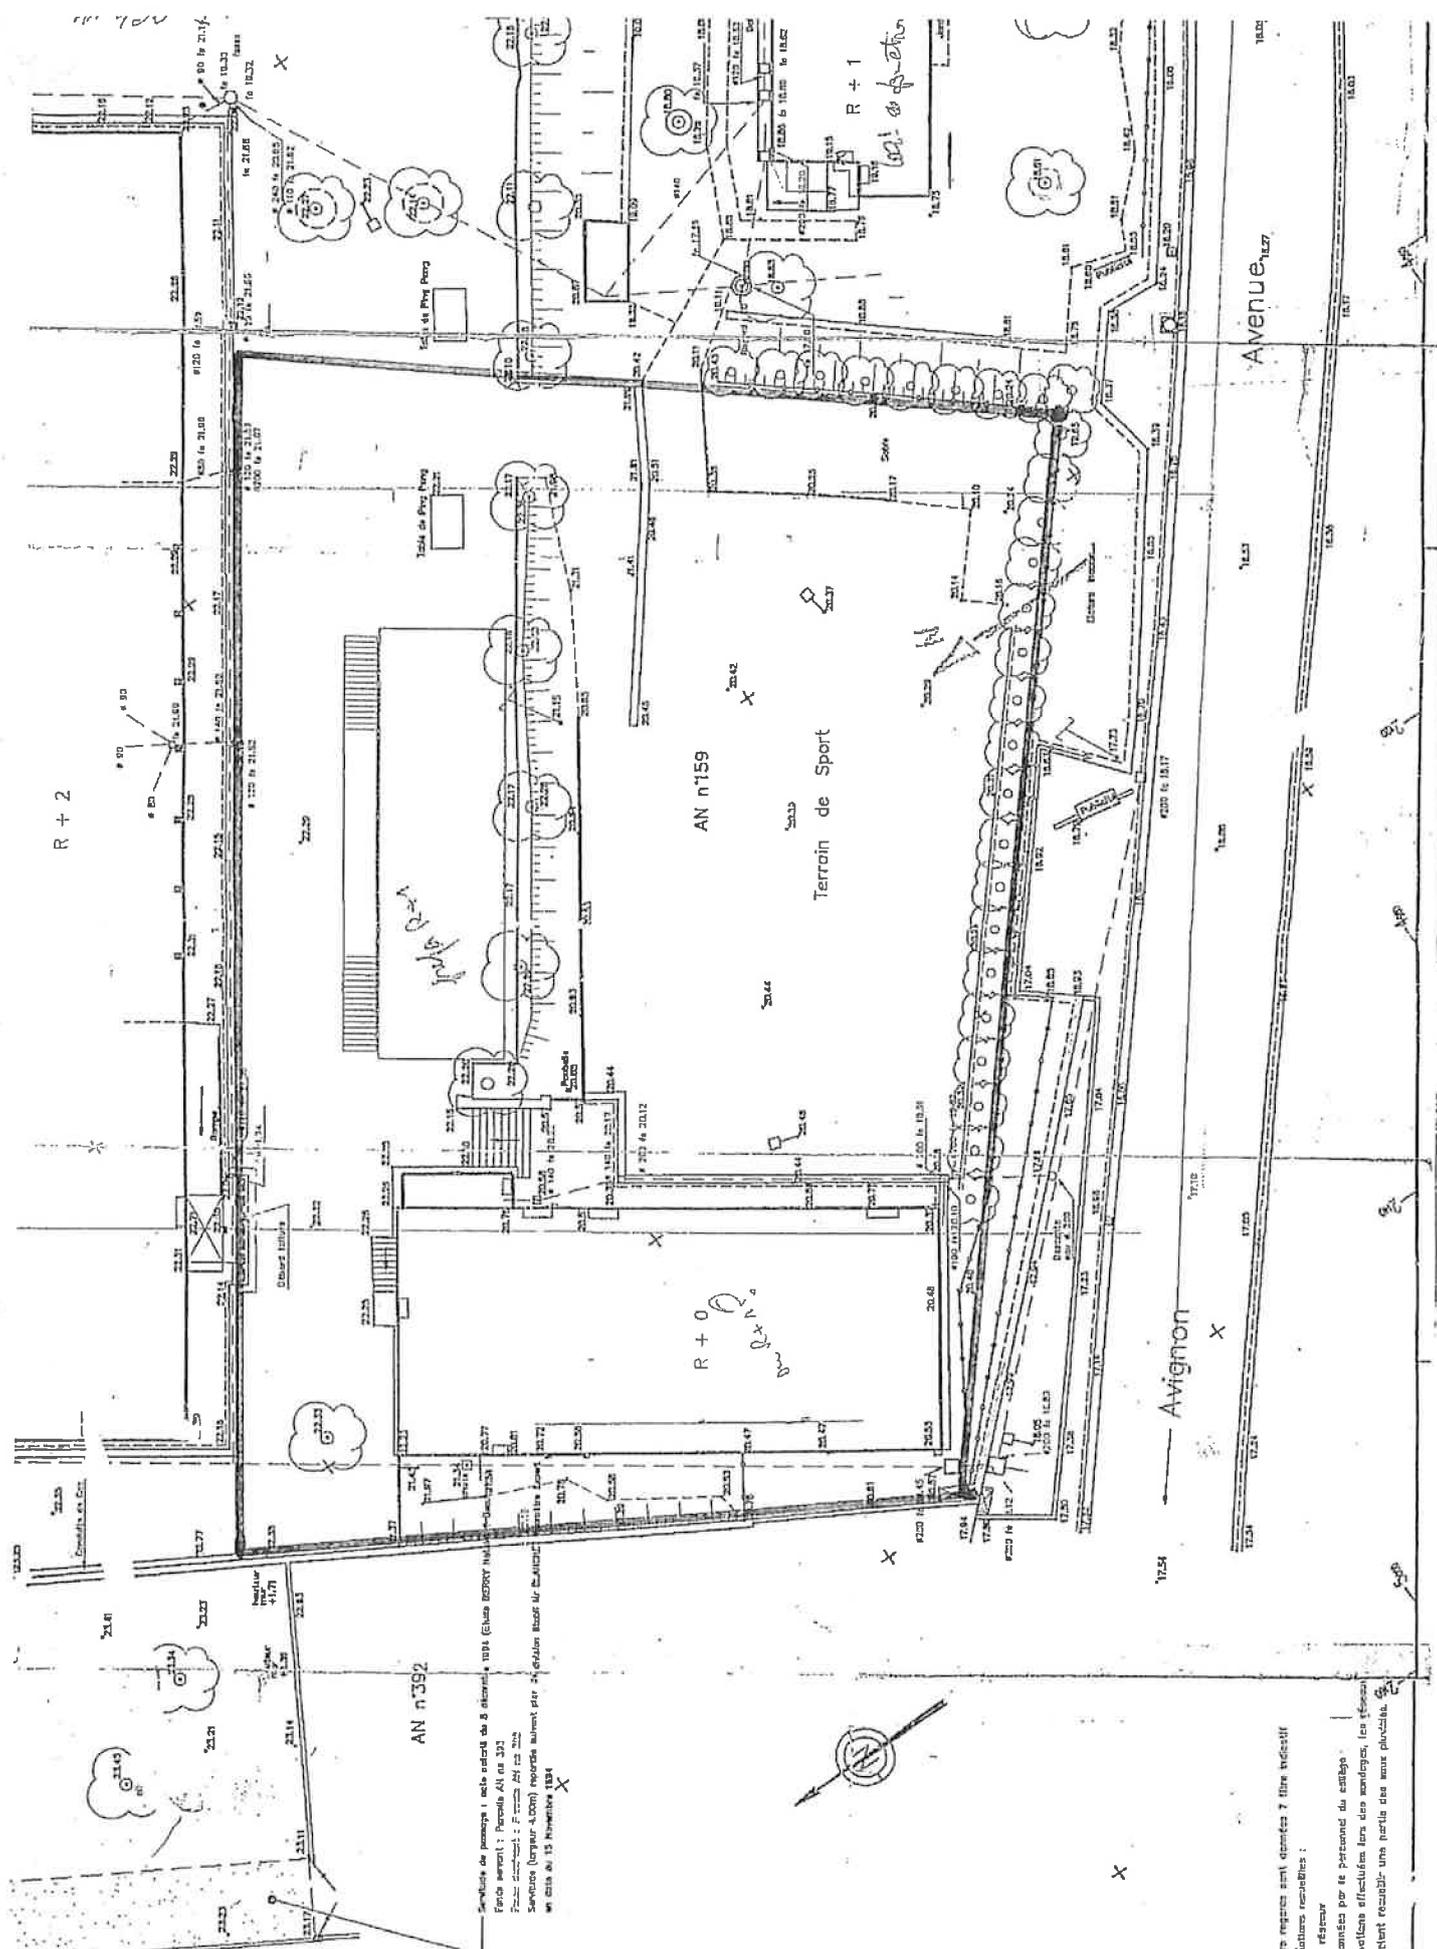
Beaucaire, collège Vigne. Situation des parcelles sondées sur fond cadastral (Beaucaire, section AN)
